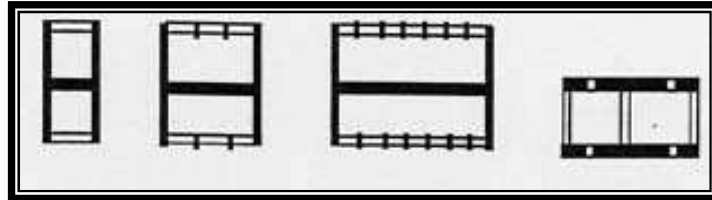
Plan type d'une tour à vent bidirectionnelle
